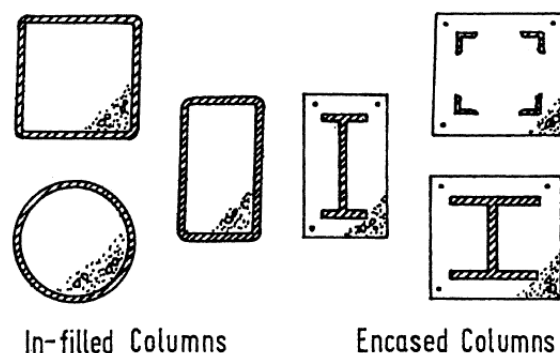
Tipos de secciones en pilares mixtos. Acero relleno de hormigón (izquierda) y acero embebido en hormigón (derecha) (Furlong, 1967).
